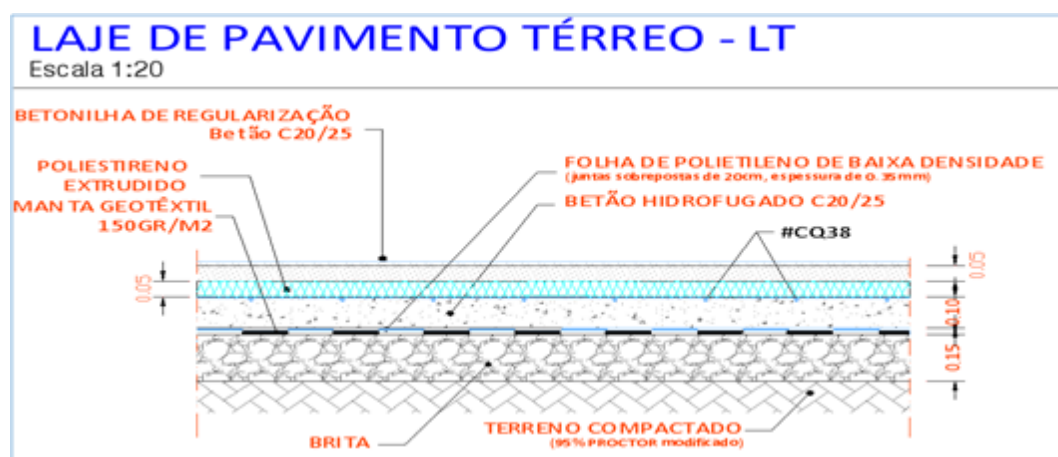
Esquema estrutural da laje de pavimento térreo. Fonte: Autor/Urbiave
